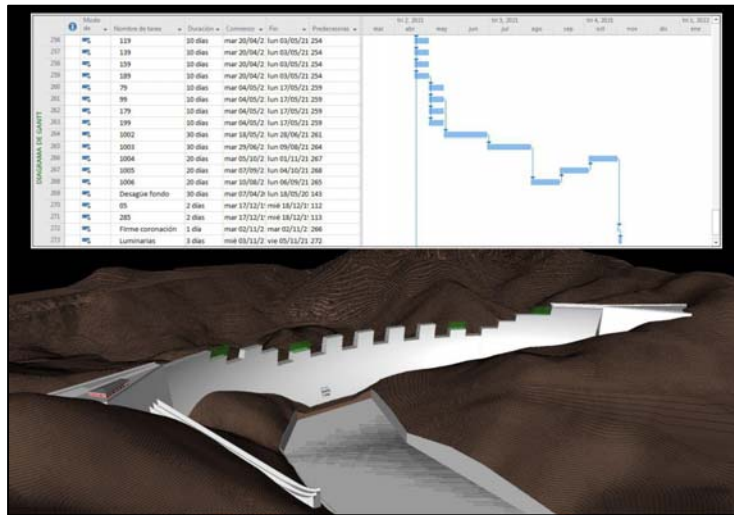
BIM 4D, planificación temporal por construcción de bloques sucesivos. Fuente: Elaboración propia
